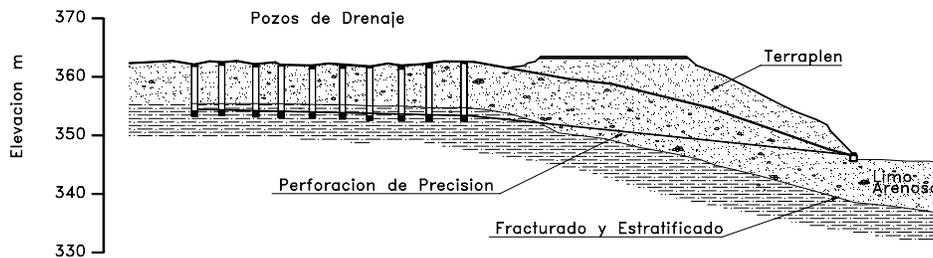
Pozos verticales conectados con ductos horizontales de PVC para drenaje (Colotta 1988).
